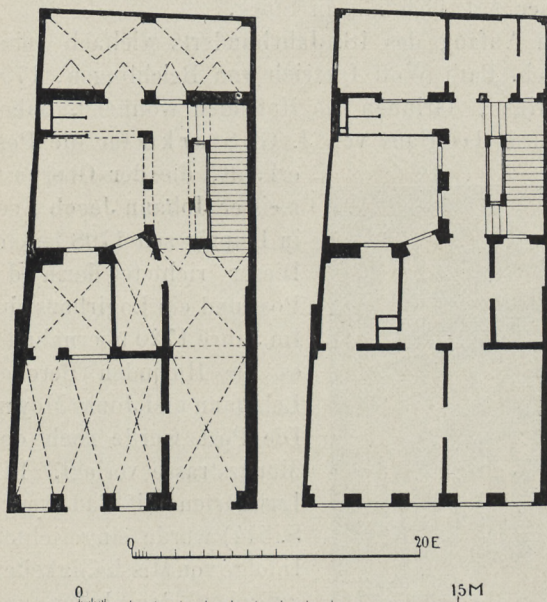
u. 536. Altmarkt Nr. 9. Grundriss des Erd- u. Obergeschosses.
